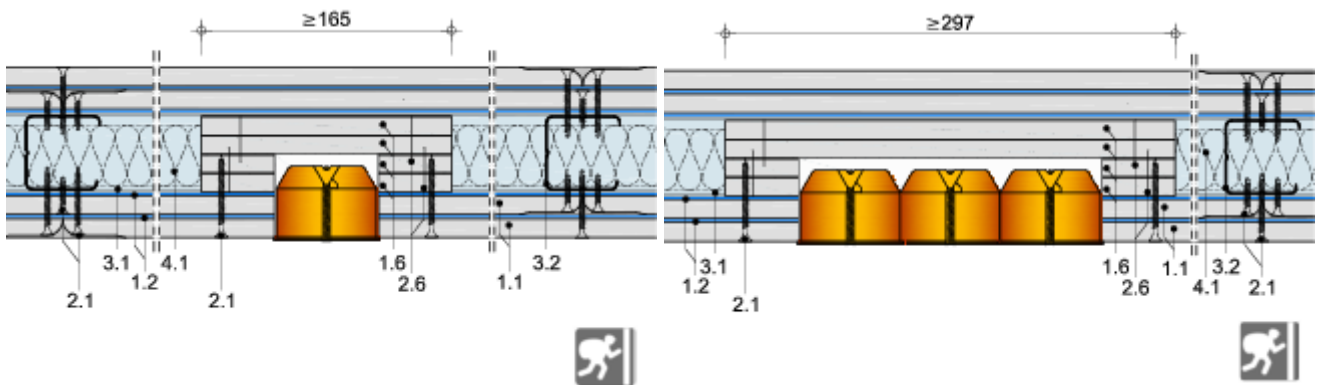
Dehnungsfuge Doppelständerwand RC 3 mit erhöhtem Schallschutz
